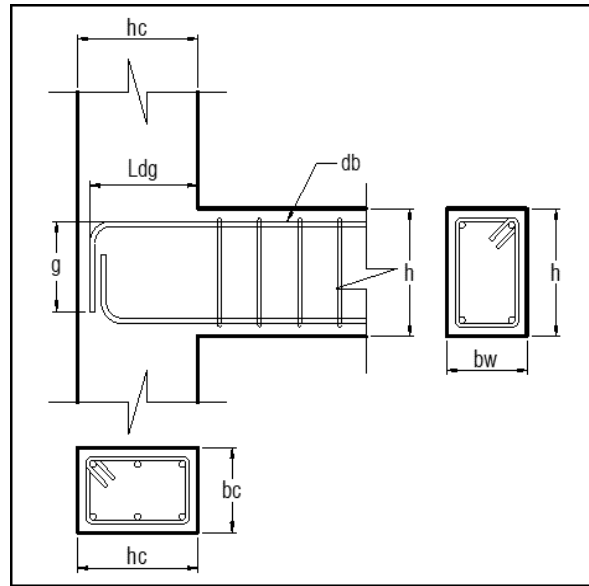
Unión Viga Columna. Fuente: Elaboración Propia.
